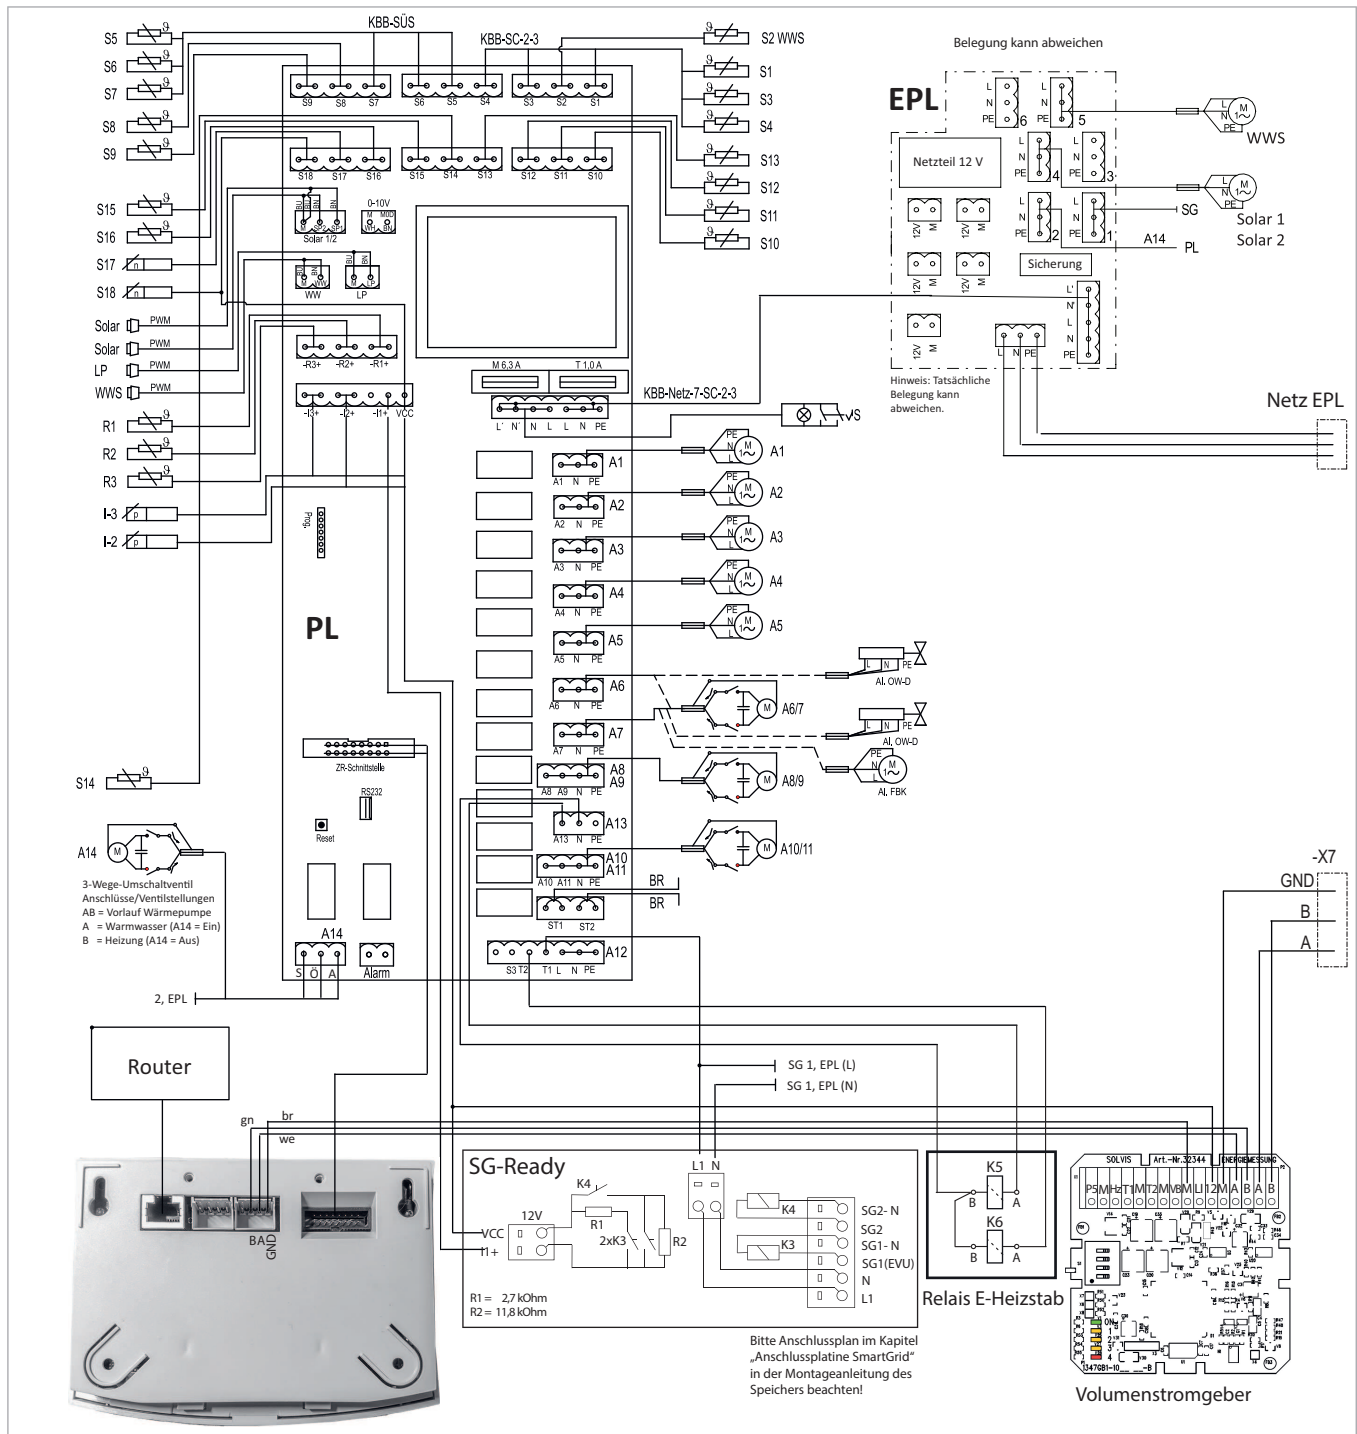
Stromlaufplan Anschluss SolvisPaula 16, Wärmepumpe mit HPT
